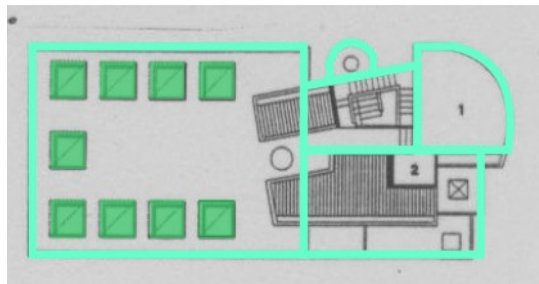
Planta da Cobertura: Repetitivo e Singular
